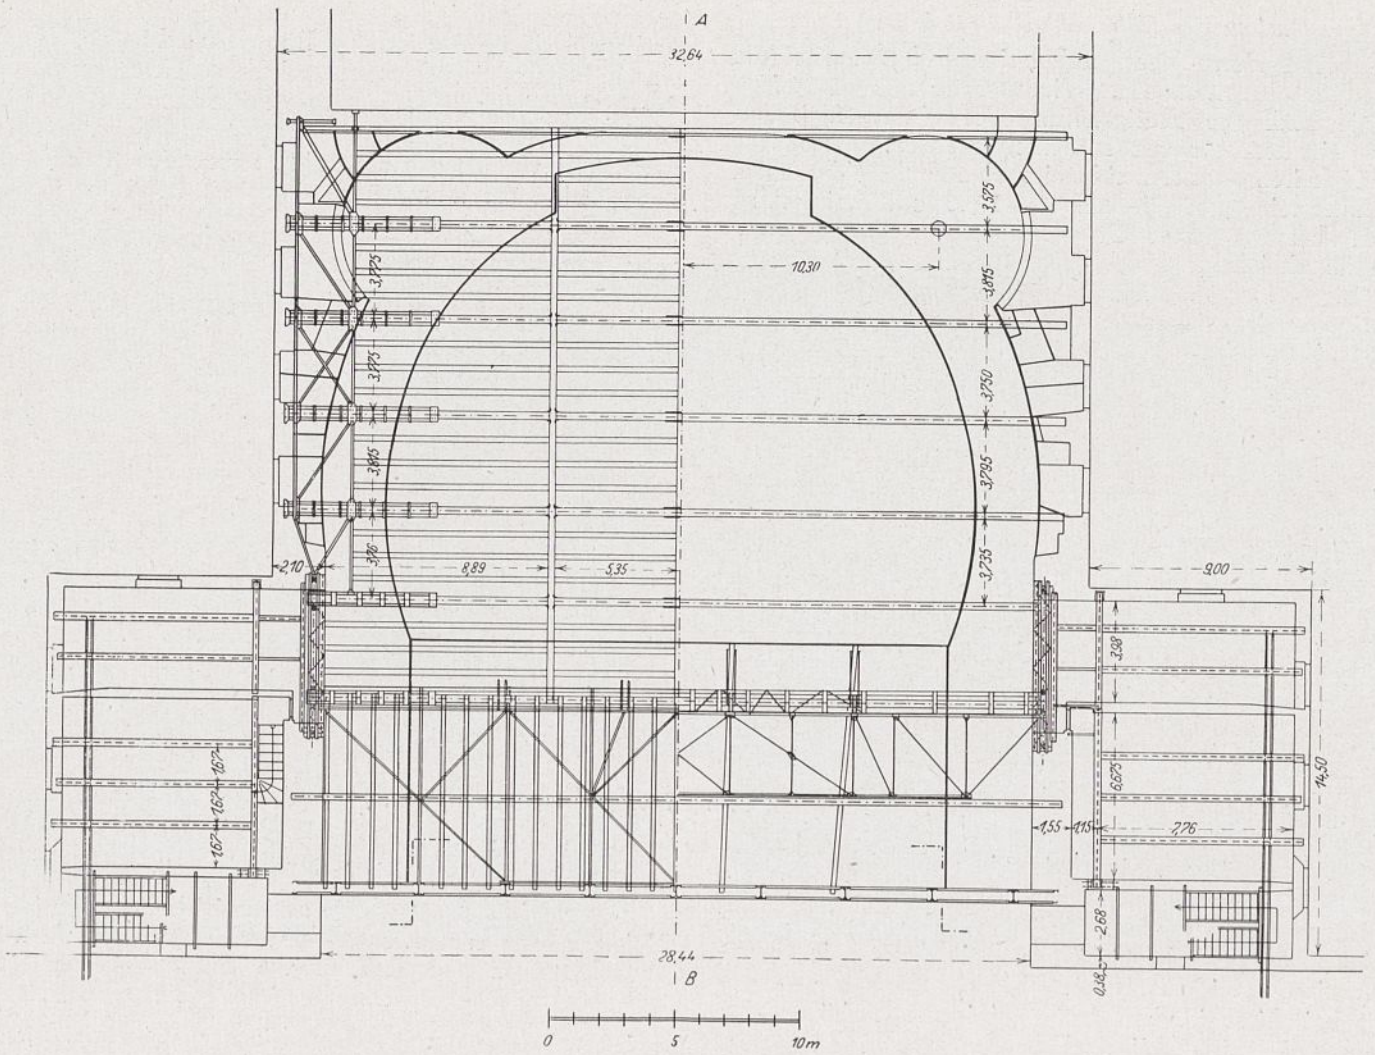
Eisenkonstruktion des Zuschauerhauses, Grundriß.
